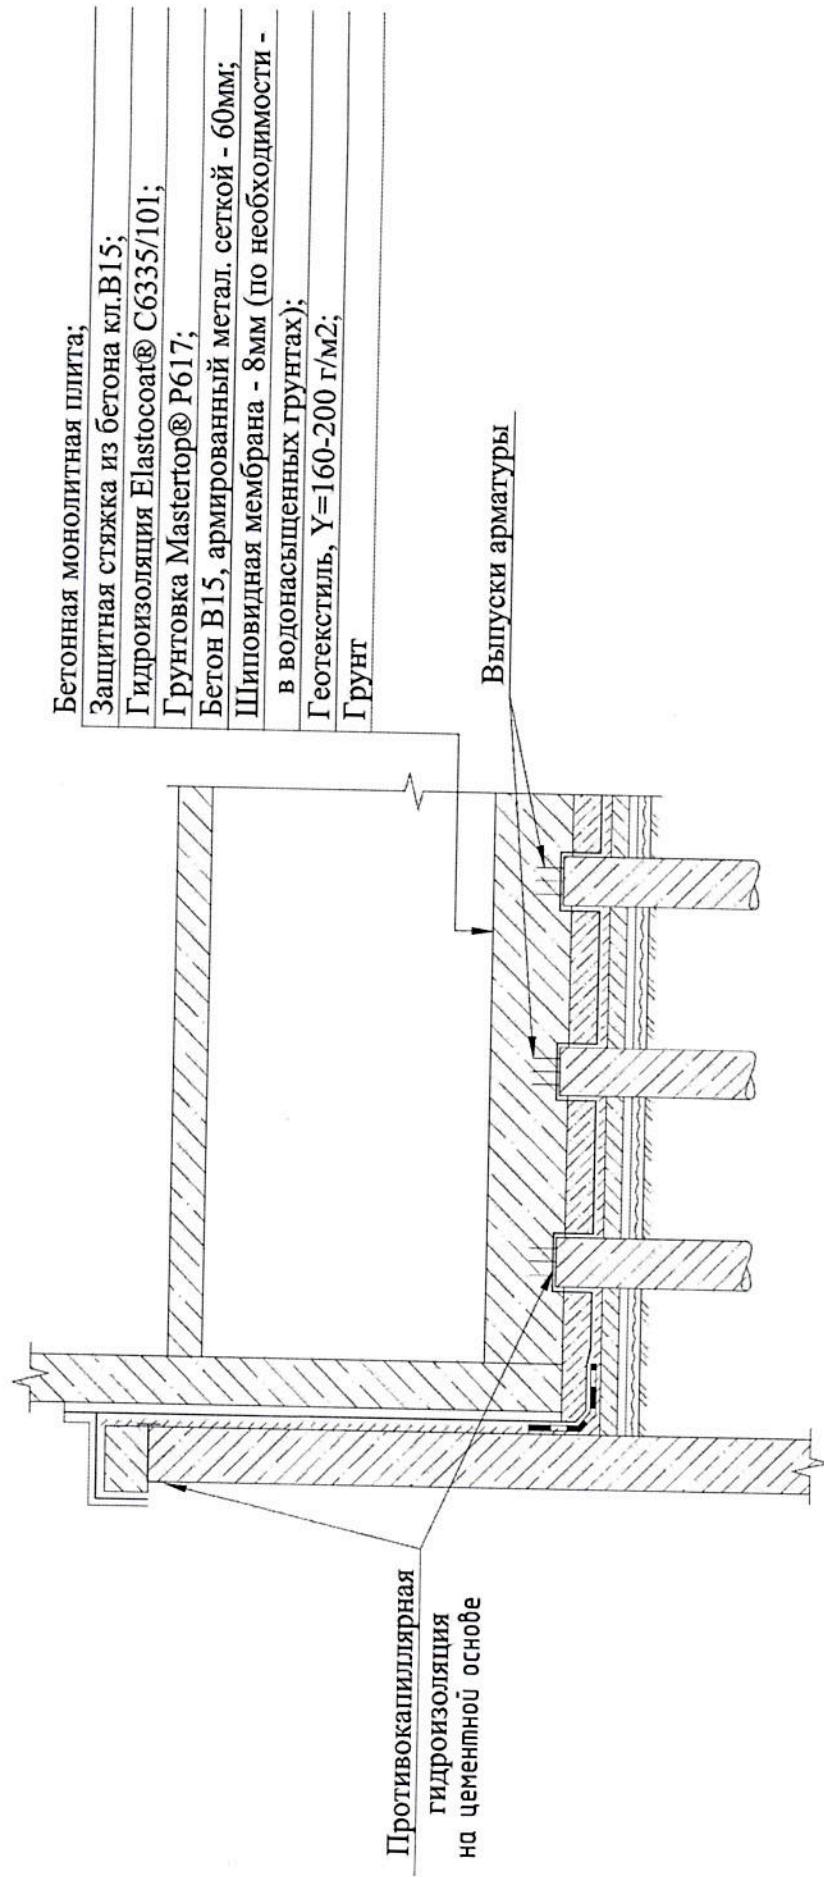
Конструктивное решение наружной гидроизоляции фундаментов зданий со свайным основанием
